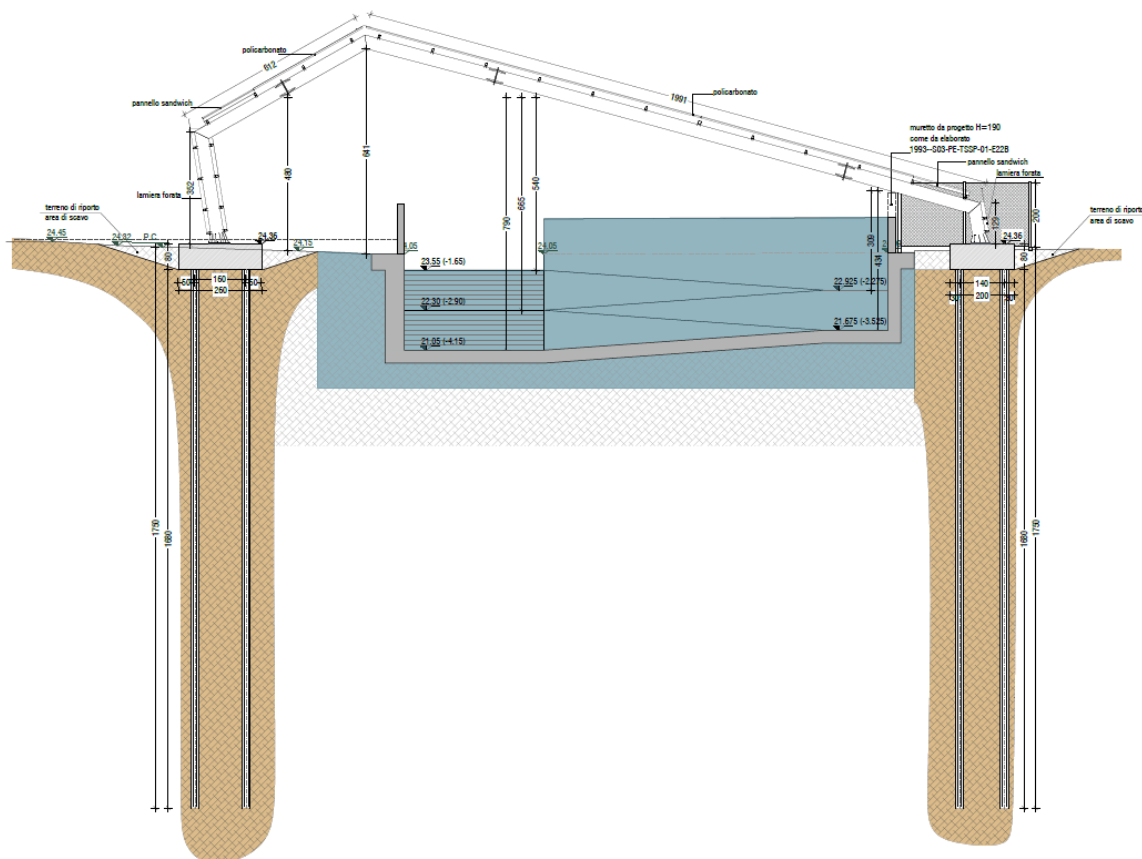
Sezione longitudinale della Tettoia metallica con identificaione del sottopasso esistente e delle strutture di fondazione profonda in progetto
